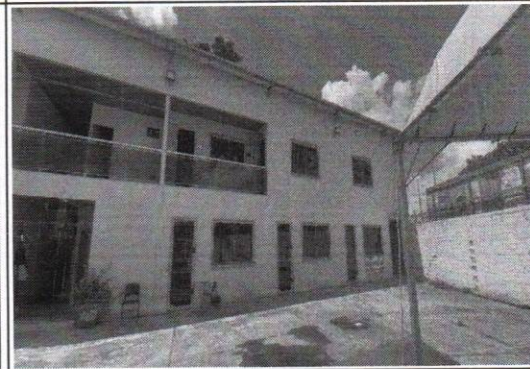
Vista do imóvel com 02 pavimentos para as salas de aula.
